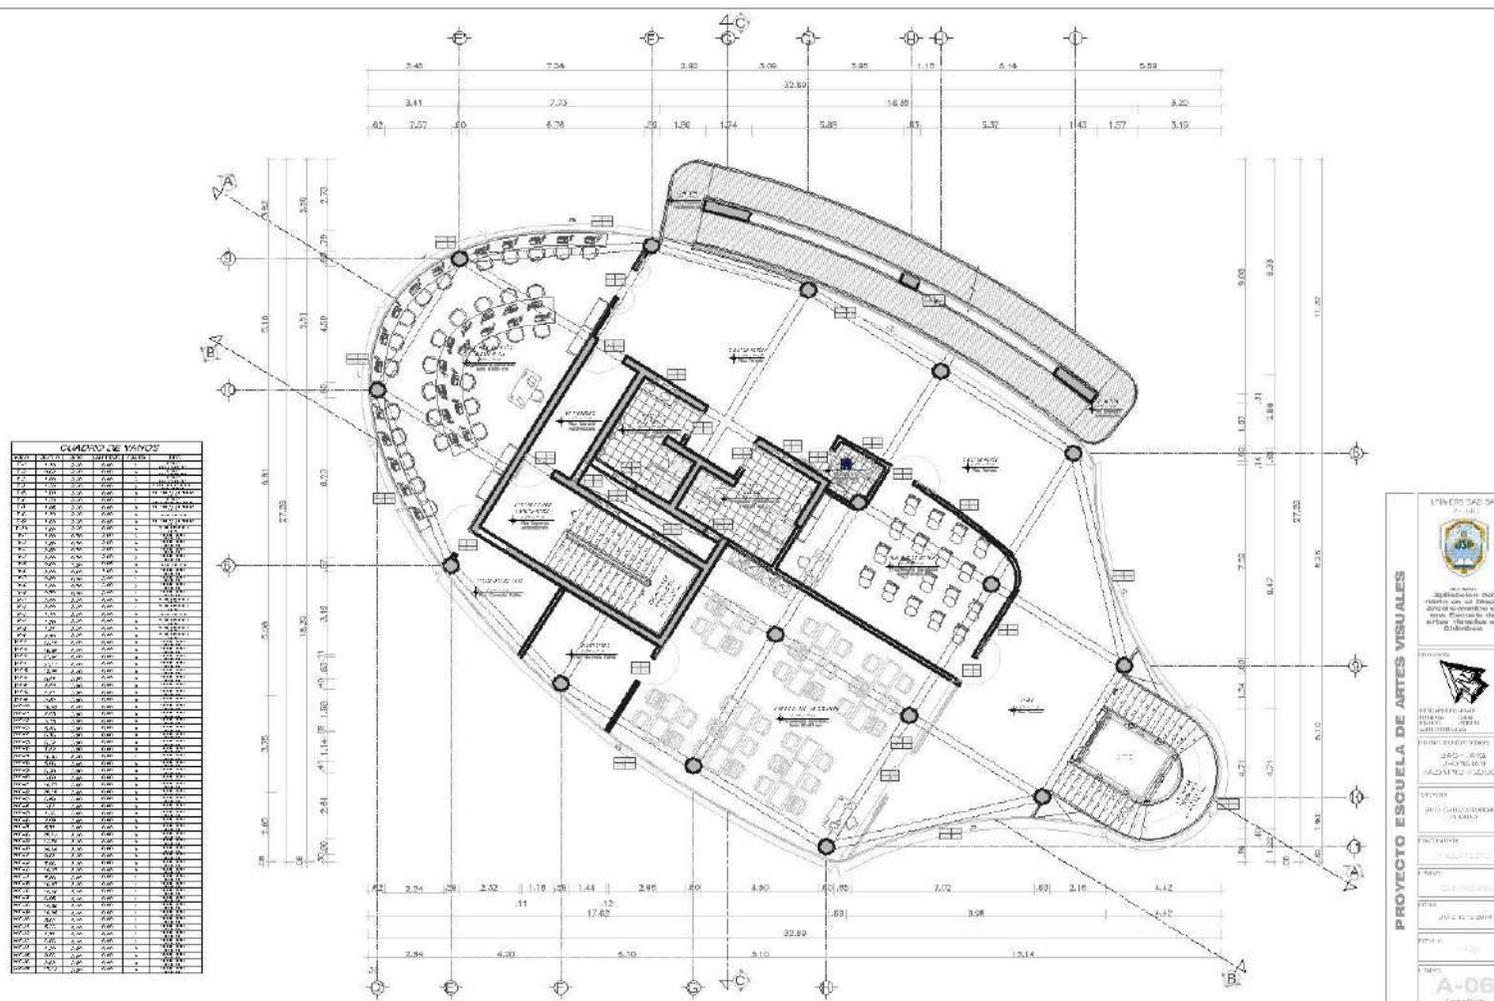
Plano de Quinto Nivel del Proyecto Arquitectónico
